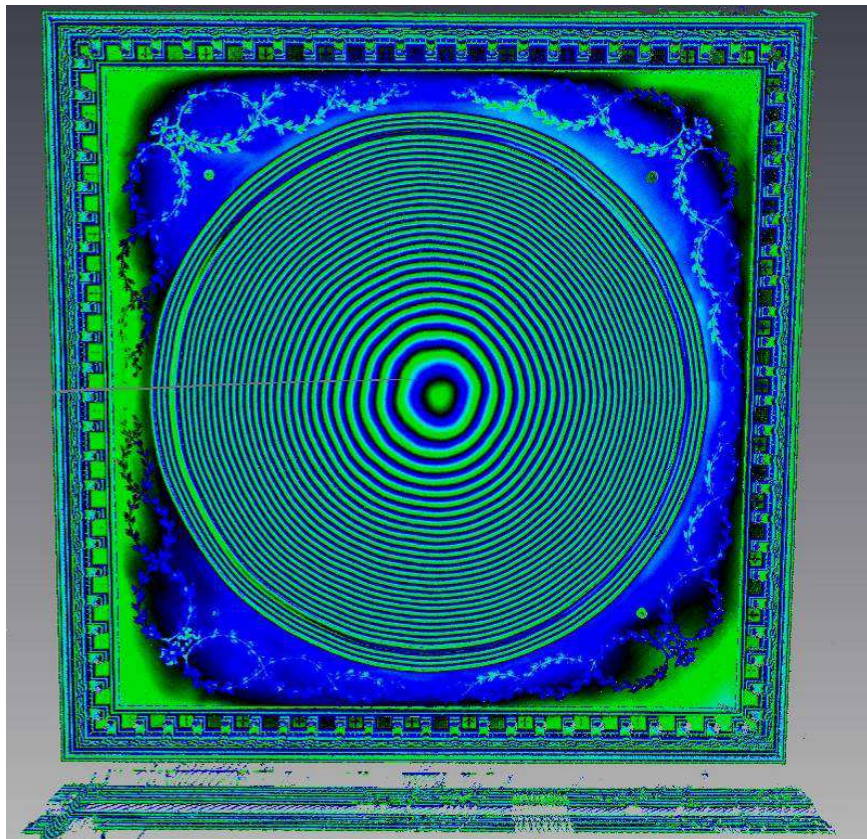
Przekrój przez chmurę punktów – widoczne oparcie jętki na plafonie.
